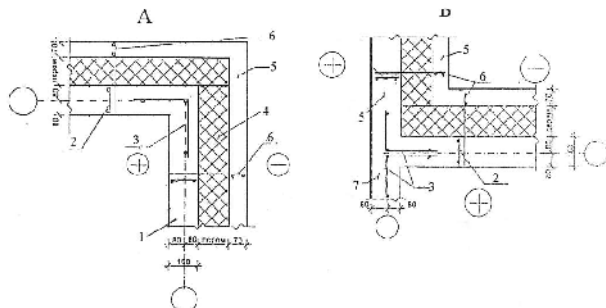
Трехслойные наружные монолитные стены: А – деталь выступающего угла наружных стен; Б – то же, входящего угла: 1 – внутренний несущий монолитный слой; 2, 3 – его армированные поперечными плоскими и гнутыми каркасами; 4 – утеплитель; 5 – наружный монолитный слой; 6 – фиксирующий арматурный каркас; 7 – внутренняя монолитная стена
